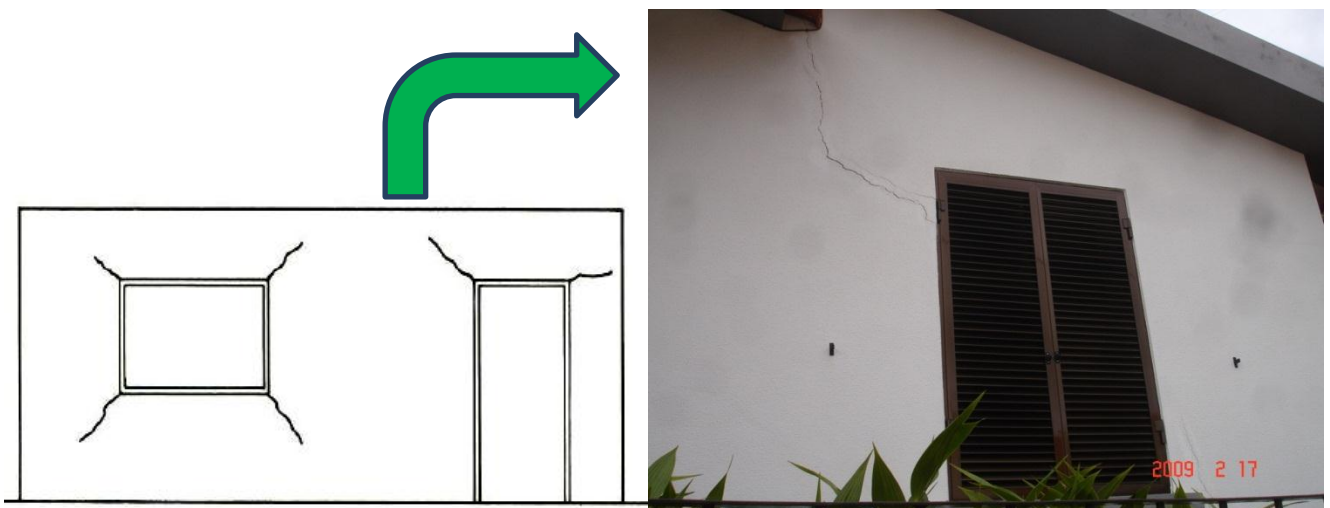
Fissuração típica nos cantos das aberturas, sob actuação de sobrecargas- Moradia N°3.
